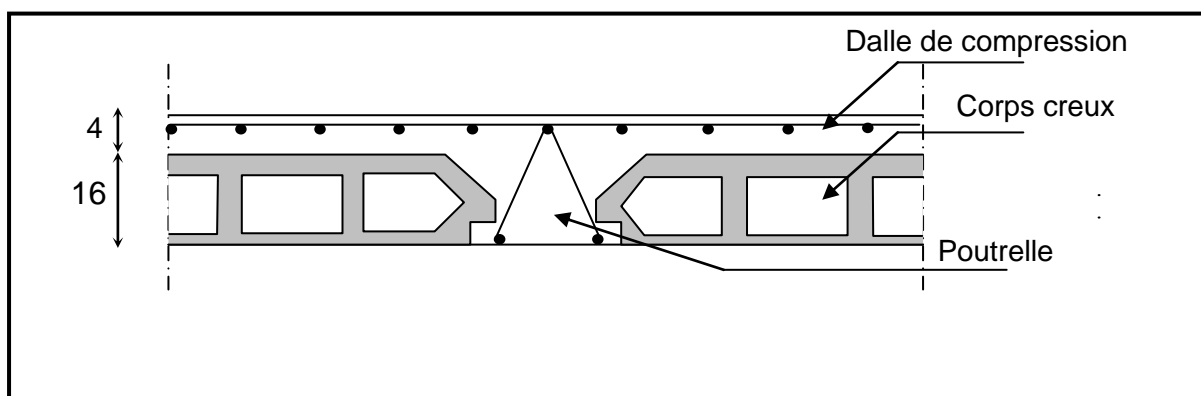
Coupe transversale d'un plancher à corps creux
